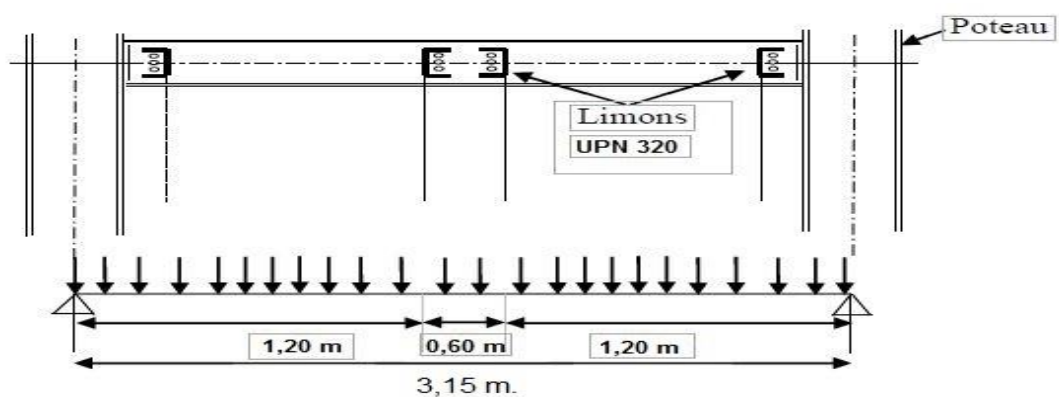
Les charges sur la poutre d'appuis des limons.
